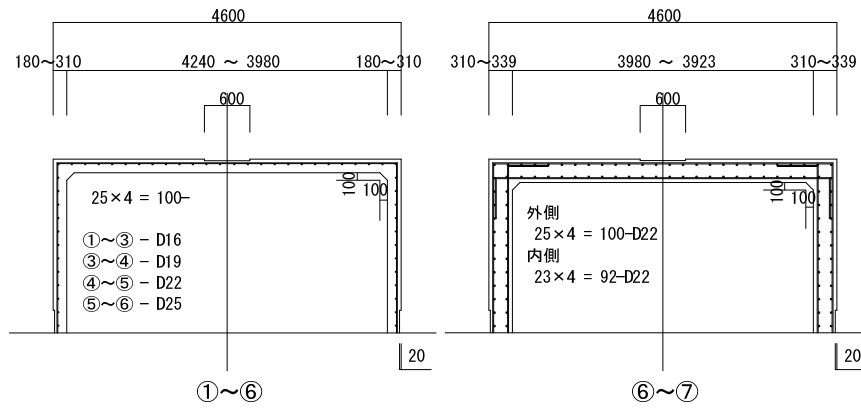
塔状工作物の鉄筋コンクリート造部分の平面断面図
